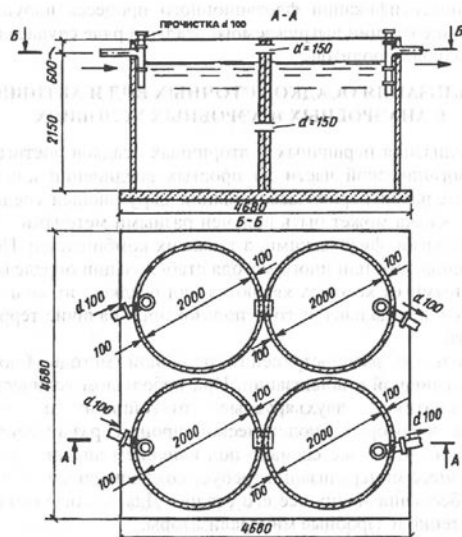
Двухкамерный септик из железобетонных колец.
